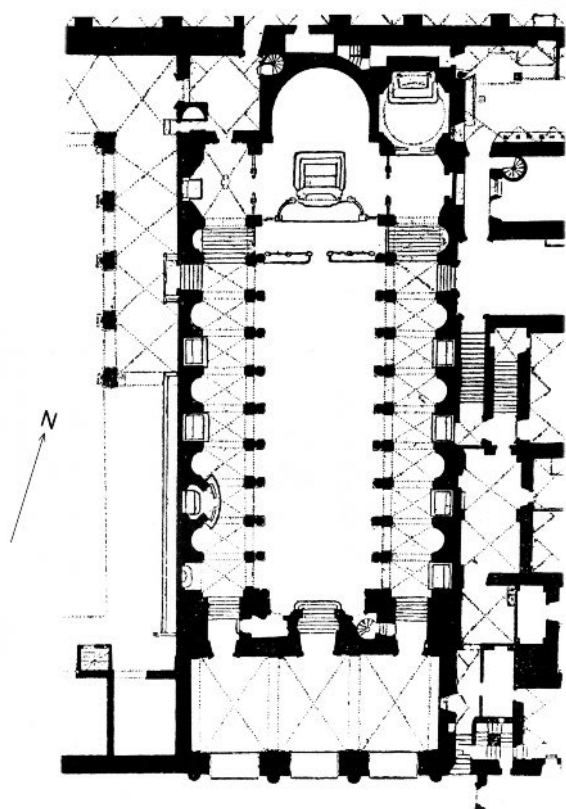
Rom, S. Marco Grundriss um 1900
